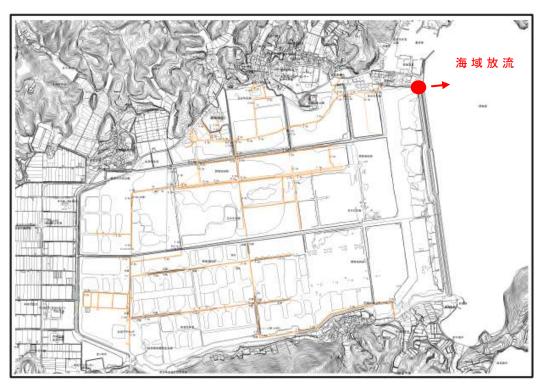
ポンプ場配置図 (赤丸部がポンプ場位置)
